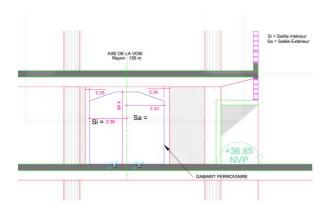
Vue en plan au niveau de la porte du bâtiment (source : ARTELIA)
